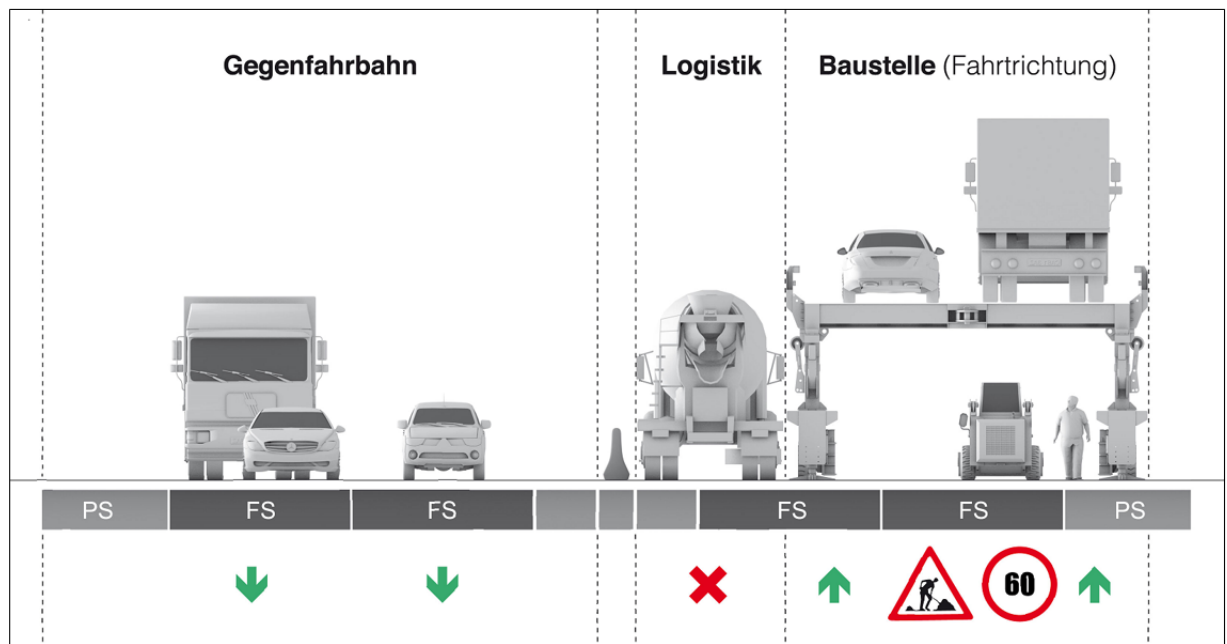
Baustelle Bereich ASTRA Bridge (ASTRA Bridge Faktenblatt, 2023)
